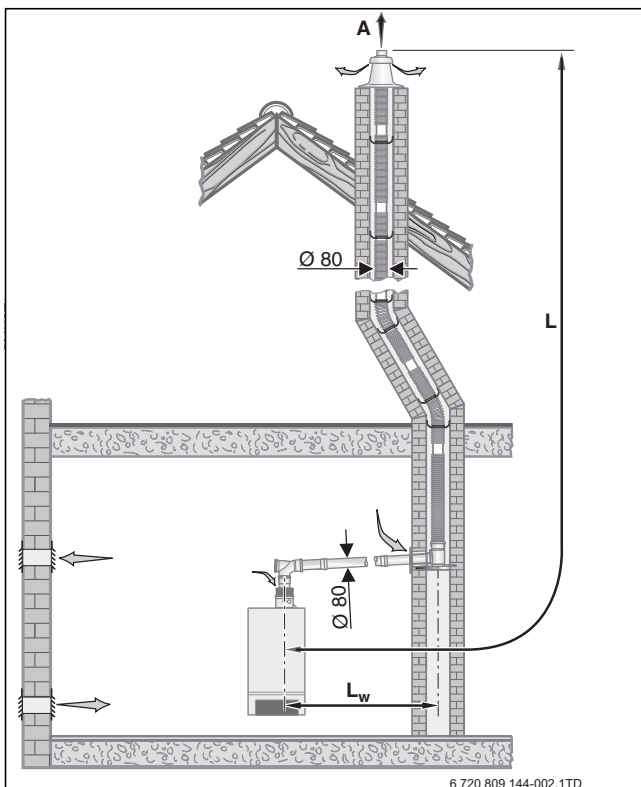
Montagevariante mit dem Bausatz GA + ÜB-Flex
